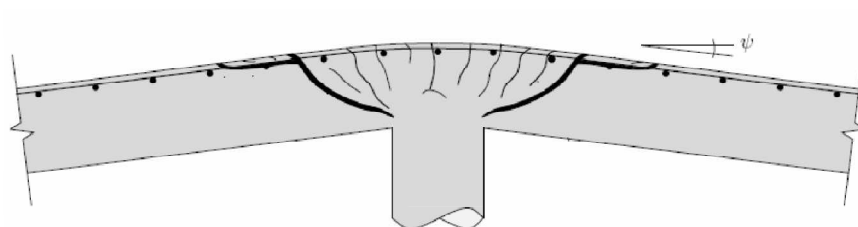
Rotação da laje em redor do pilar (MC2010)
